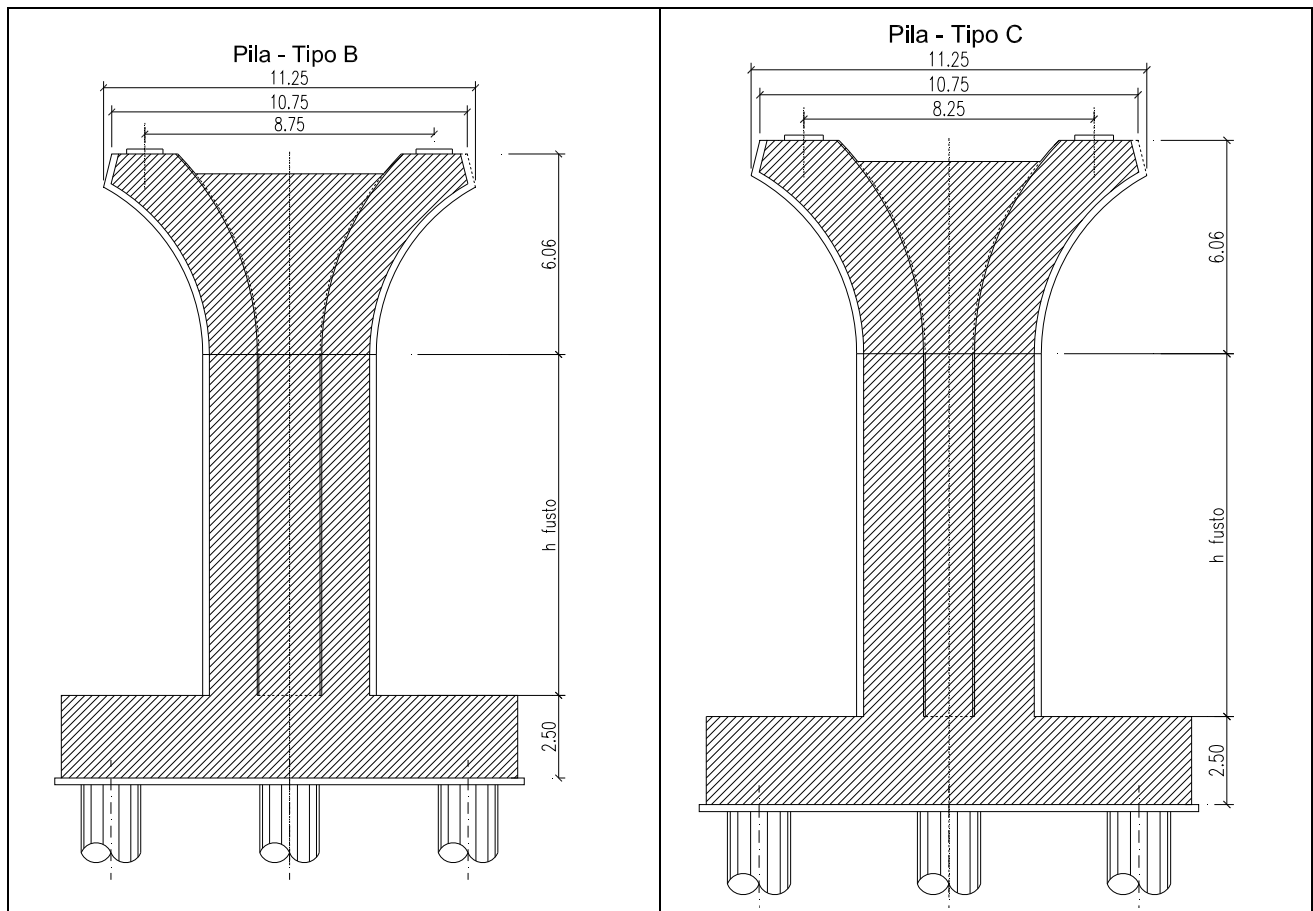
Sezione trasversale pila Tipo B e Tipo C
